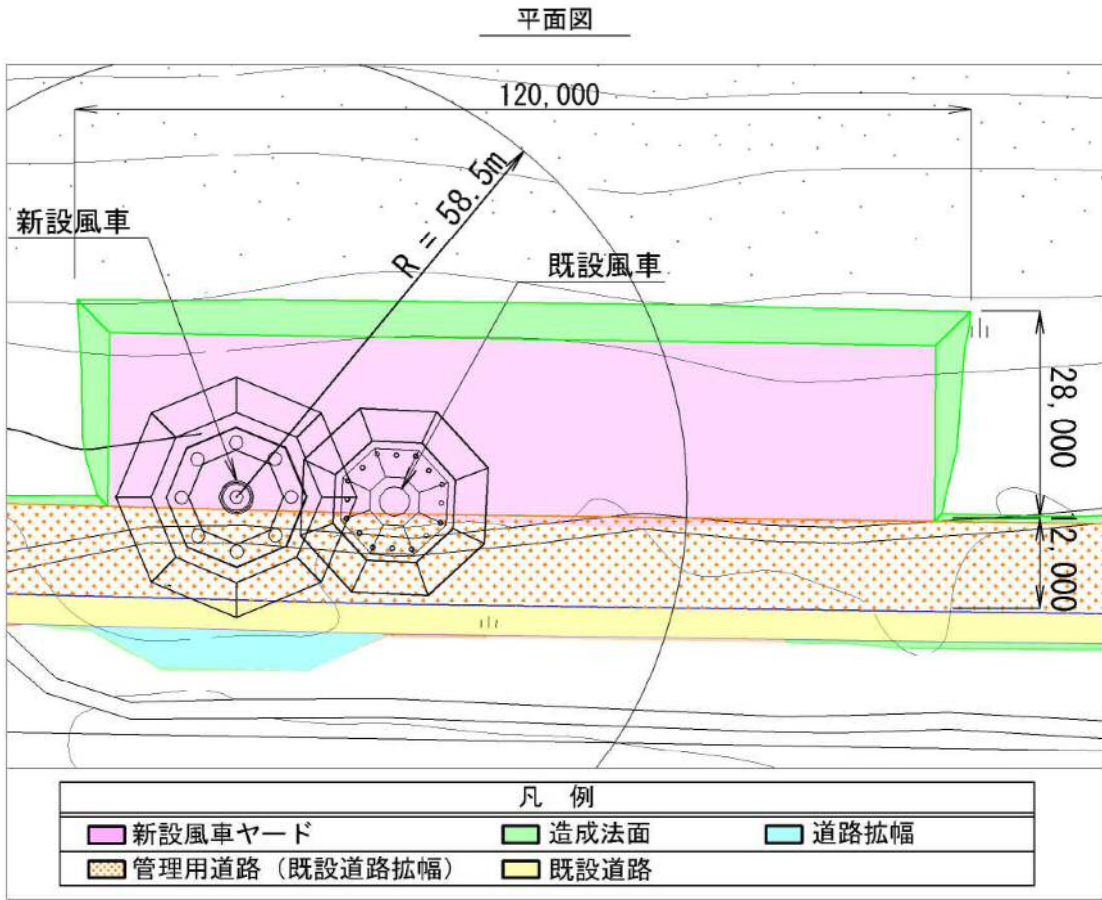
(6) 造成平面・横断計画図 (新設 6 号機)
